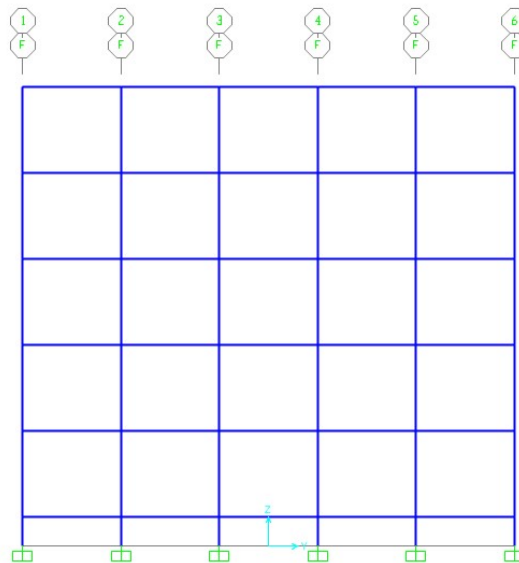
Pórtico F dirección Y / vista 2D SAP 2000.
